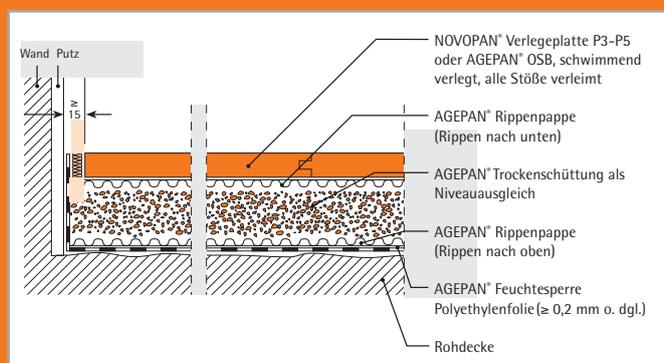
Das schwimmende Verlegen auf Stahlbetondecken mit AGEPAN® Trockenschüttung.
